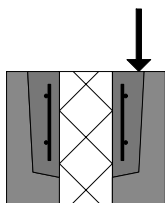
Prefabrikkert overdekningsbjelke støpt i Leca betong. Figuren viser systemet tilpasset vegg av 300 mm Leca Isoblokk med 100mm EPS-isolasjon sentrisk plassert.
